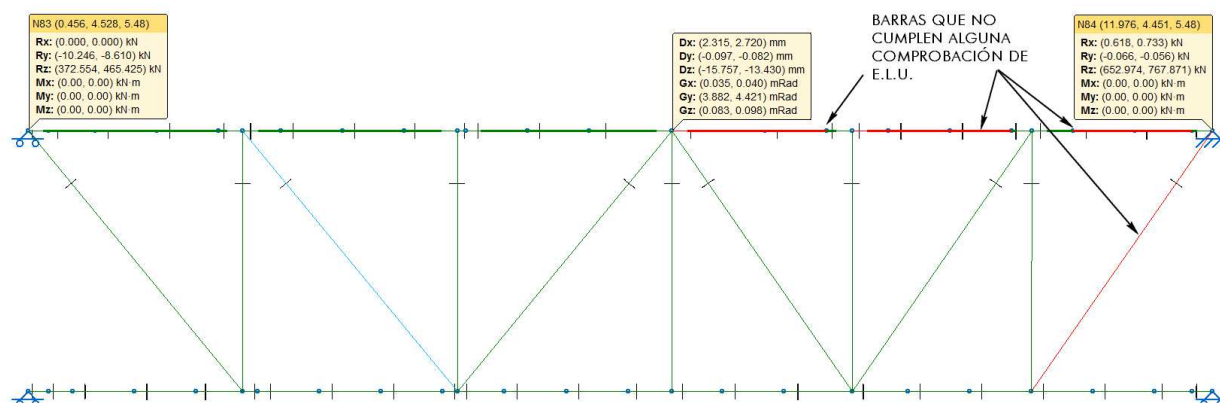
Cercha sin apoyo en soporte inclinado y pilar reforzado. Envoltorio de reacciones características y de desplazamientos en el nudo central situado bajo muro 1M. Secciones de barras según apartado 4.7.3.4
